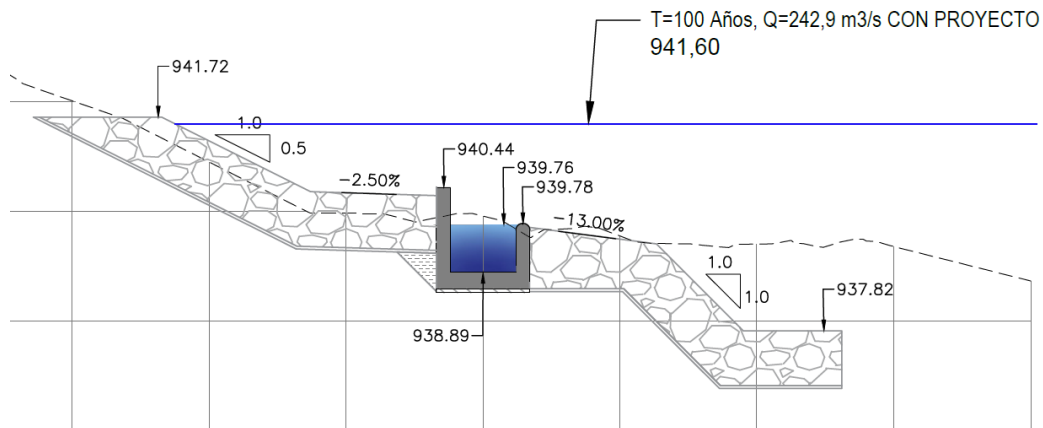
Sección transversal canal de conexión y enrocado de protección
